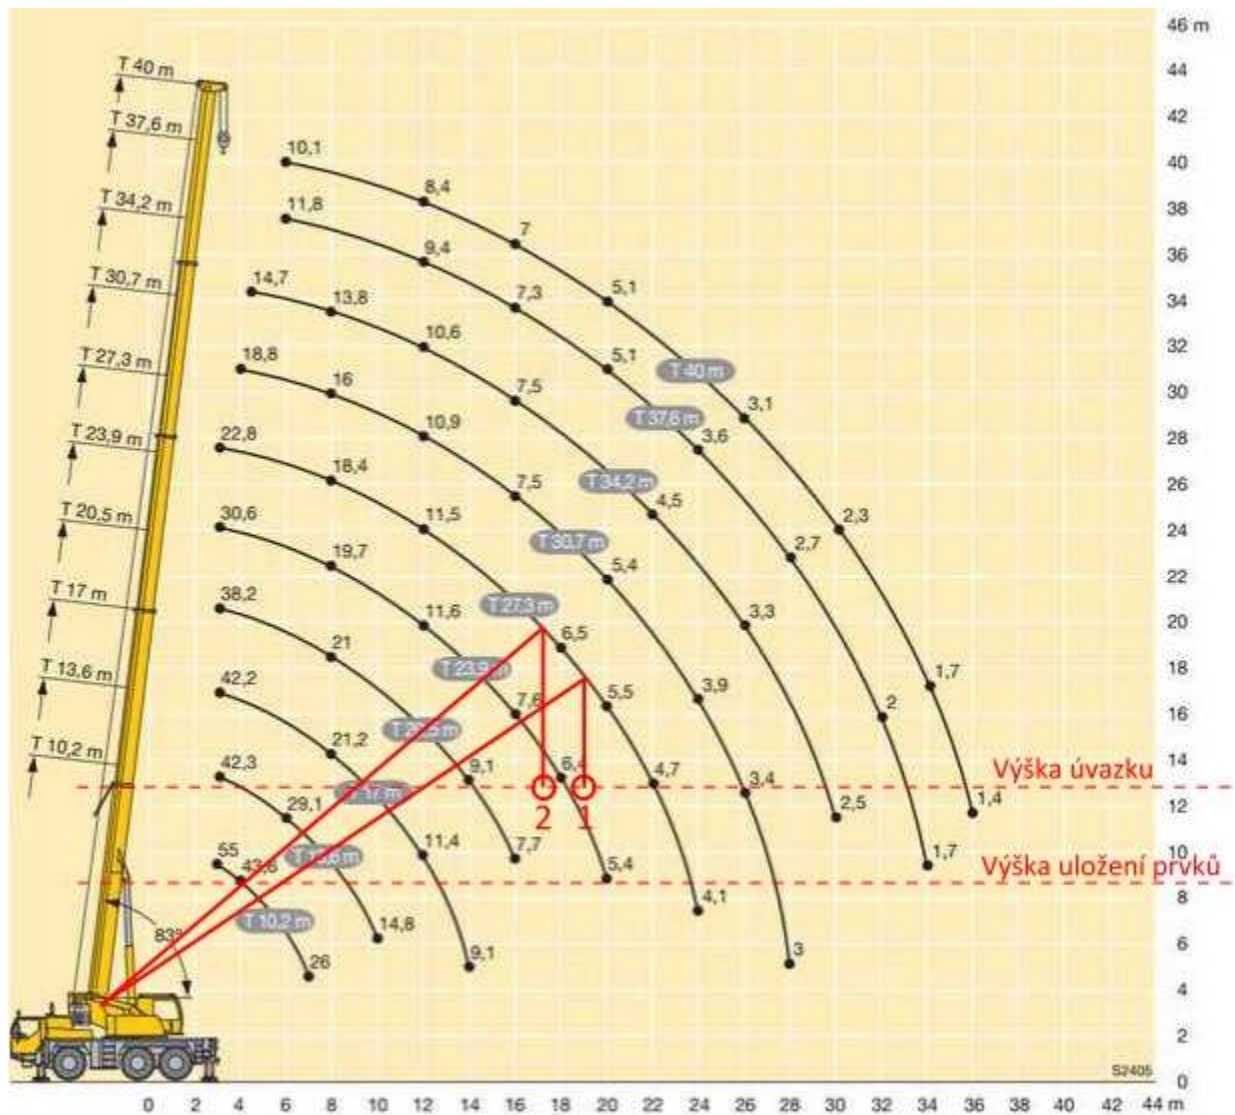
Autojeřáb Leibherr LTM 1055/1 [29]
